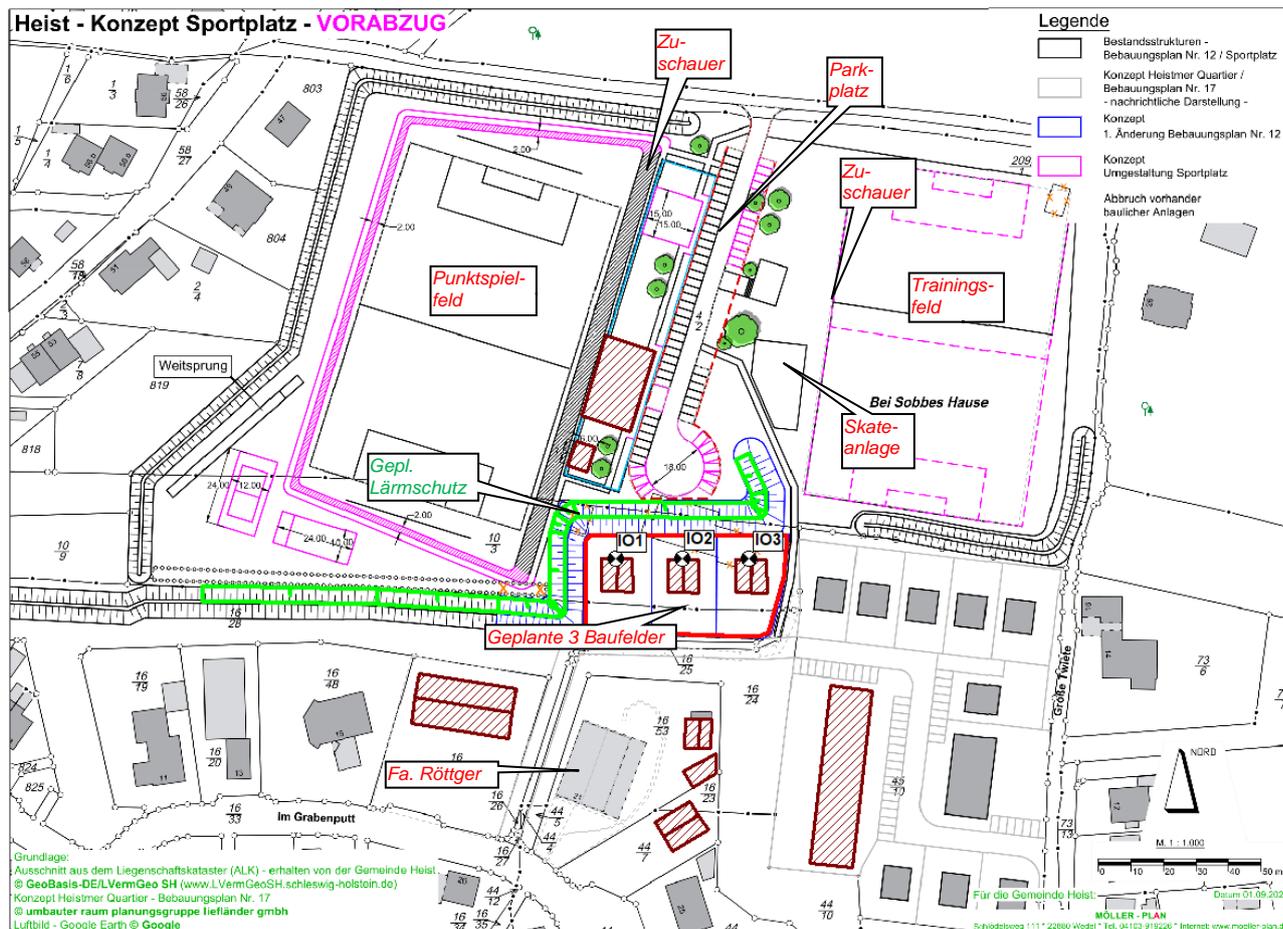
Konzept der Sportanlage der Gemeinde Heist an der Hamburger Straße in Heist mit 3 geplanten Baufeldern für Wohngebäude am südlichen Rand (Möller - Plan; Vorabzug Bearbeitungsstand: 01.09.2021)
